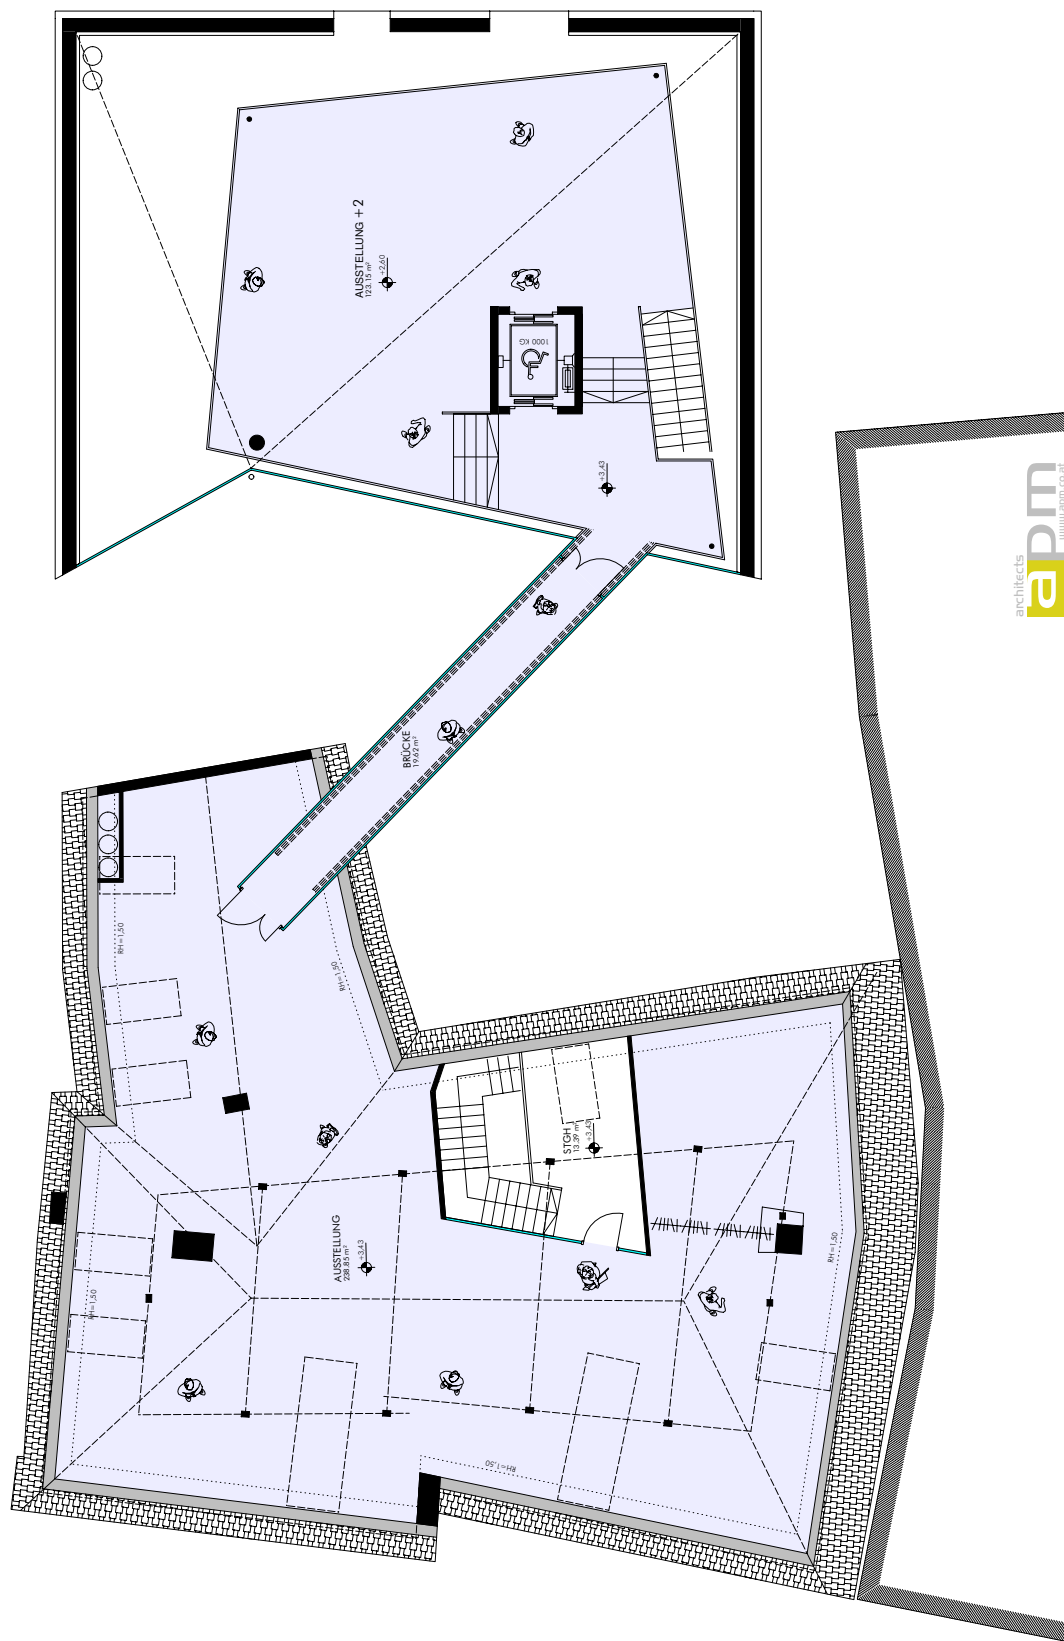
Entwurf Art-Center Dachgeschoß, © apm ZT GmbH
